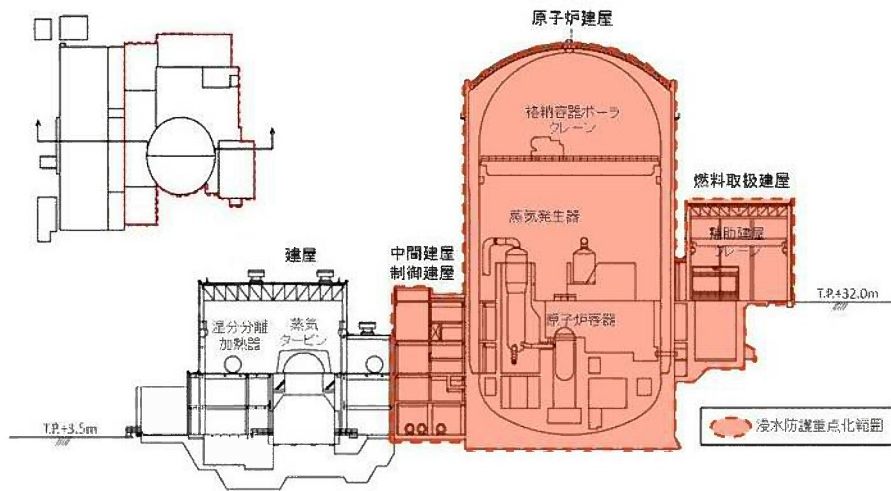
建屋断面図及び浸水防護重点化範囲（東西方向）
